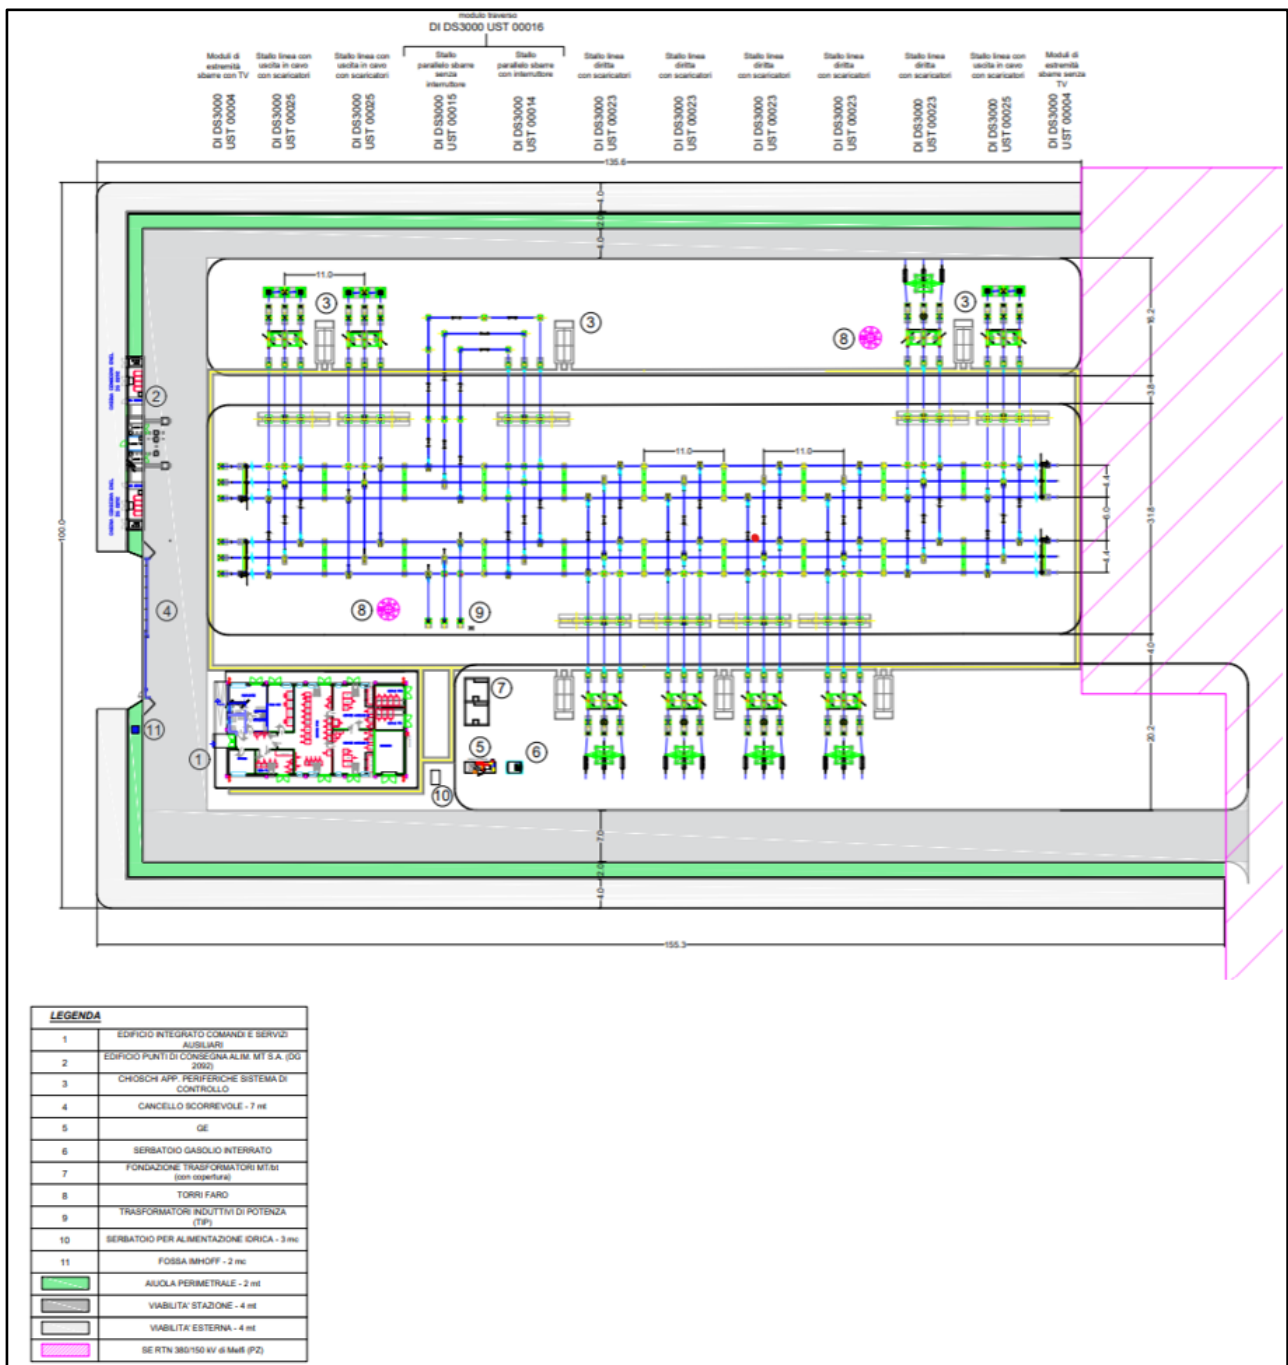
Planimetria elettromeccanica dell'ampliamento della SE RTN 380/150 kV
